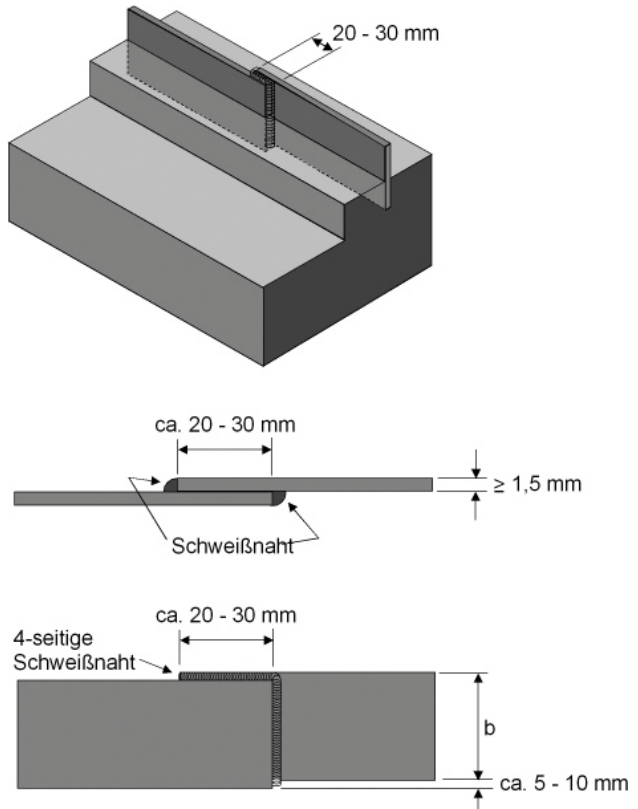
Geschweißter Stoß bei Fugenblechen
